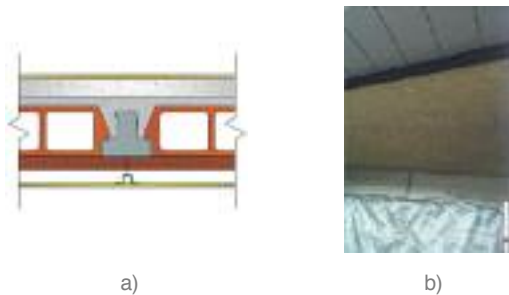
Isolamento na face inferior de pavimentos: a) desenho esquemático; b) situação real com aplicação de lã mineral.
